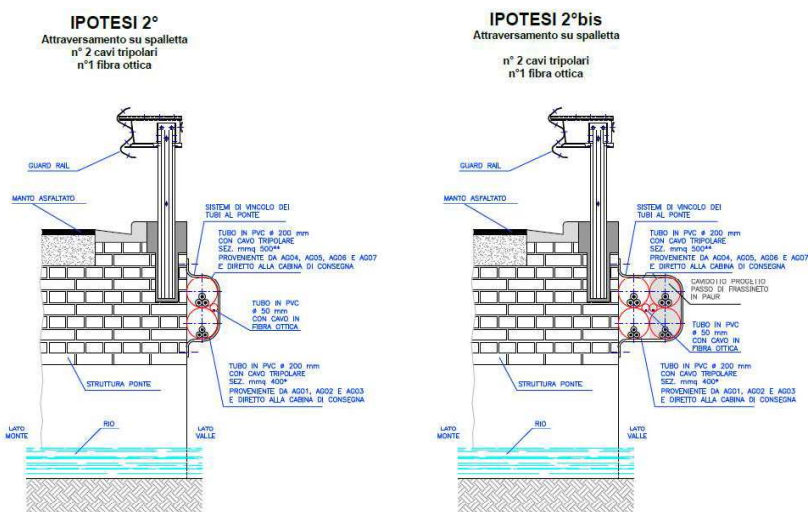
Sezione tipologica di attraversamento su spalletta
